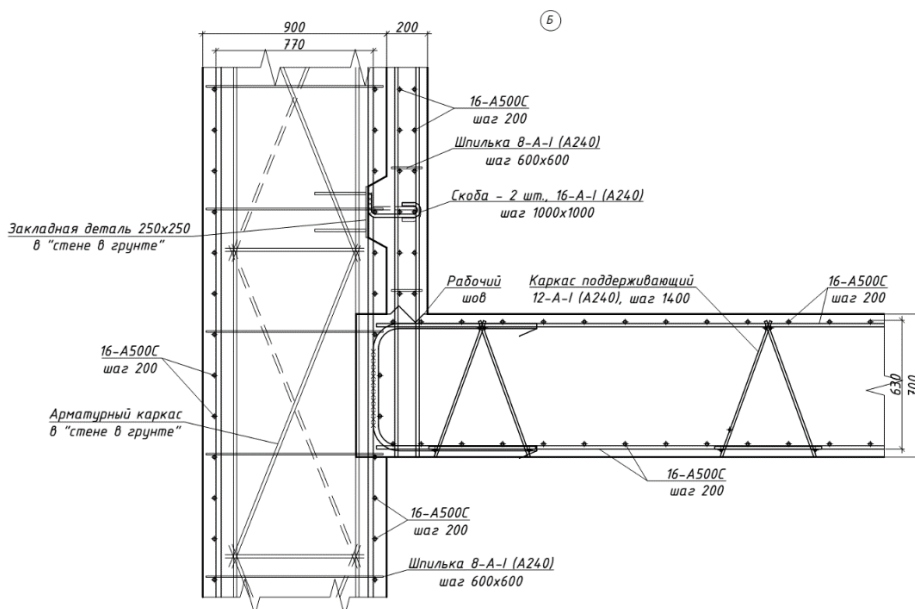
Конструкция узла сопряжение дна резервуара со «стеной в грунте»
